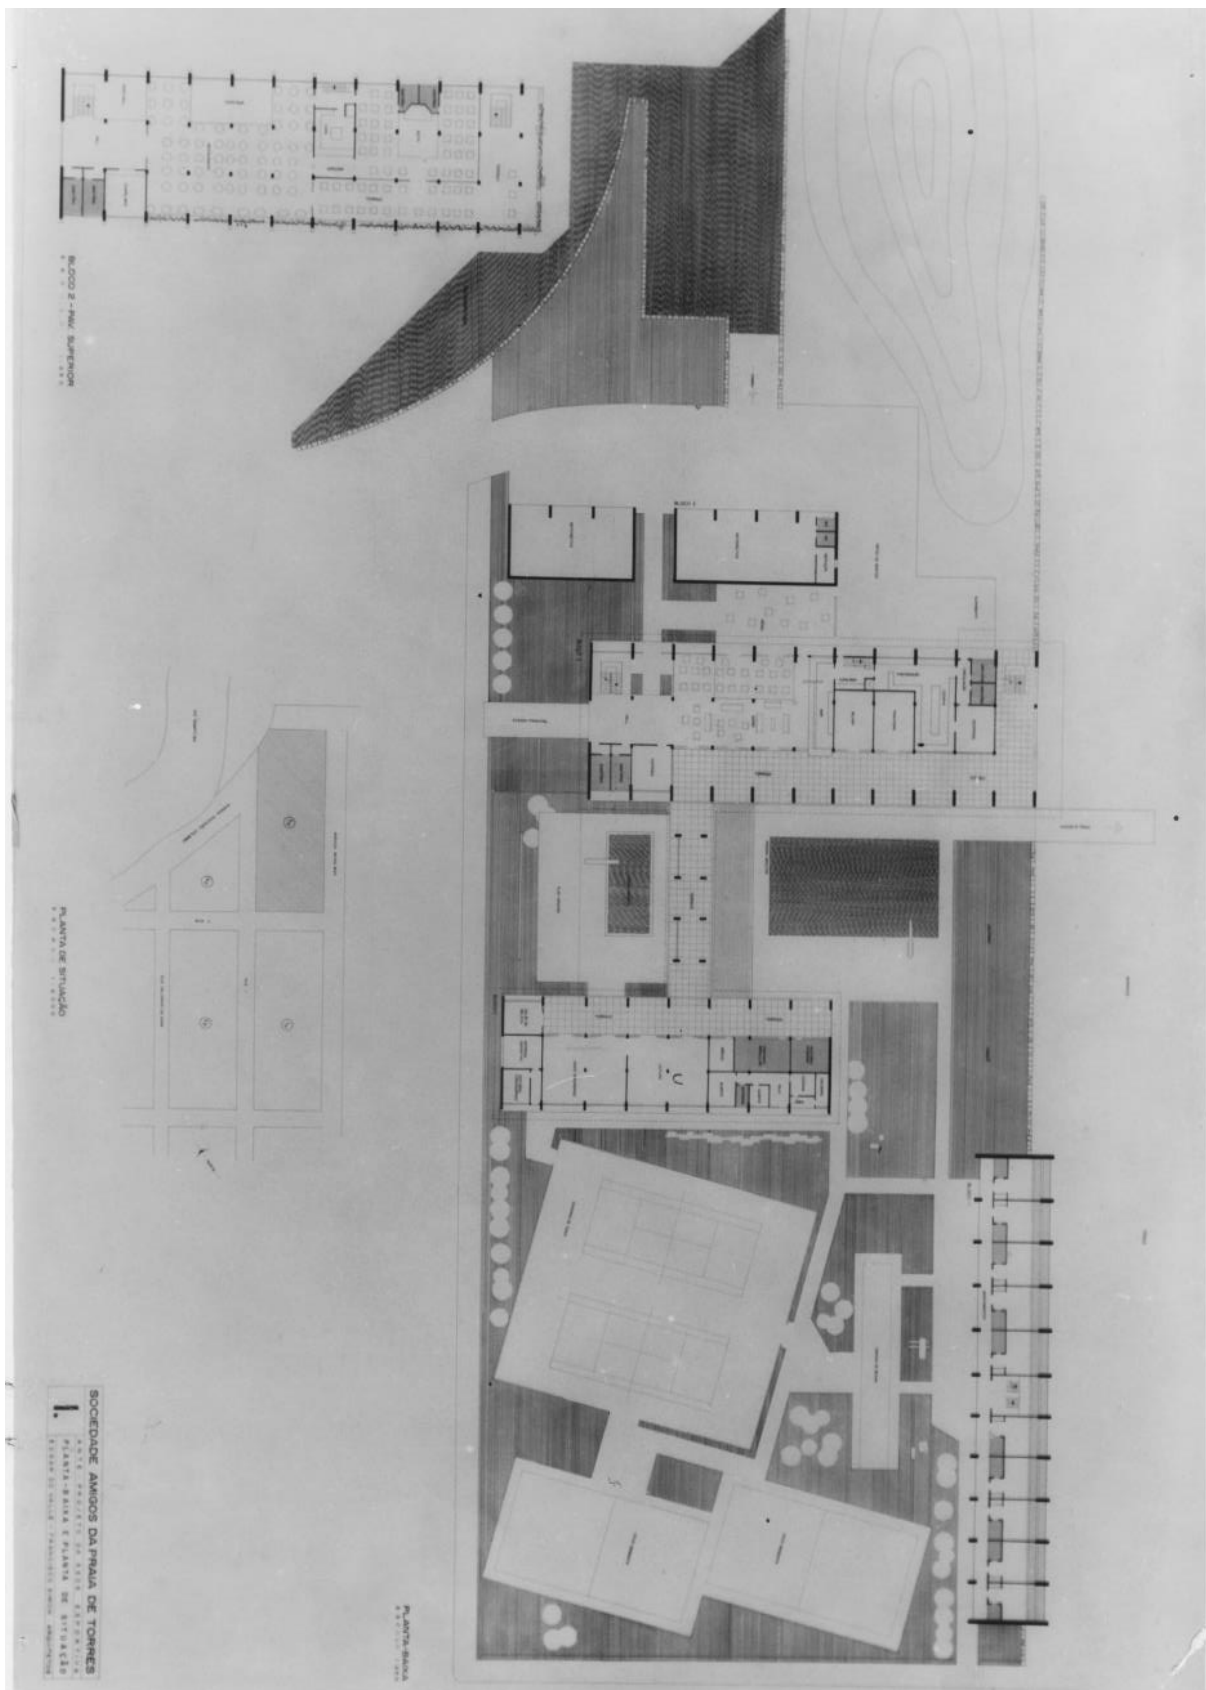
Anteprojeto da sede esportiva da SAPT. Planta baixa e planta de situação. Valle e Simch Arquitetos (1964). Fonte: Museu Três Torres. Digitalizado por Luana Gonzalez Bassa
